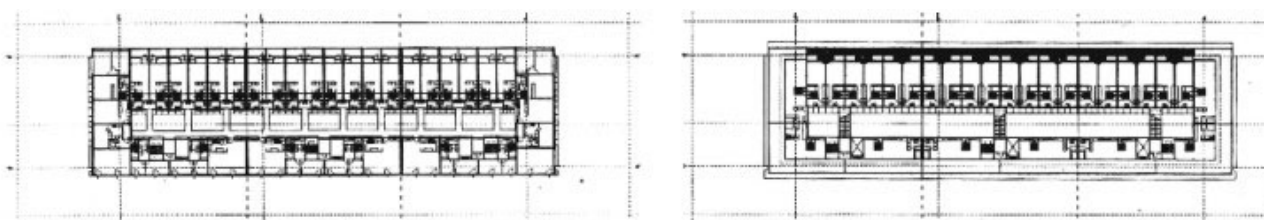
planta 4º e 5º pavimento do Galpão 8. Fonte: Revista Arquis nº 1.
